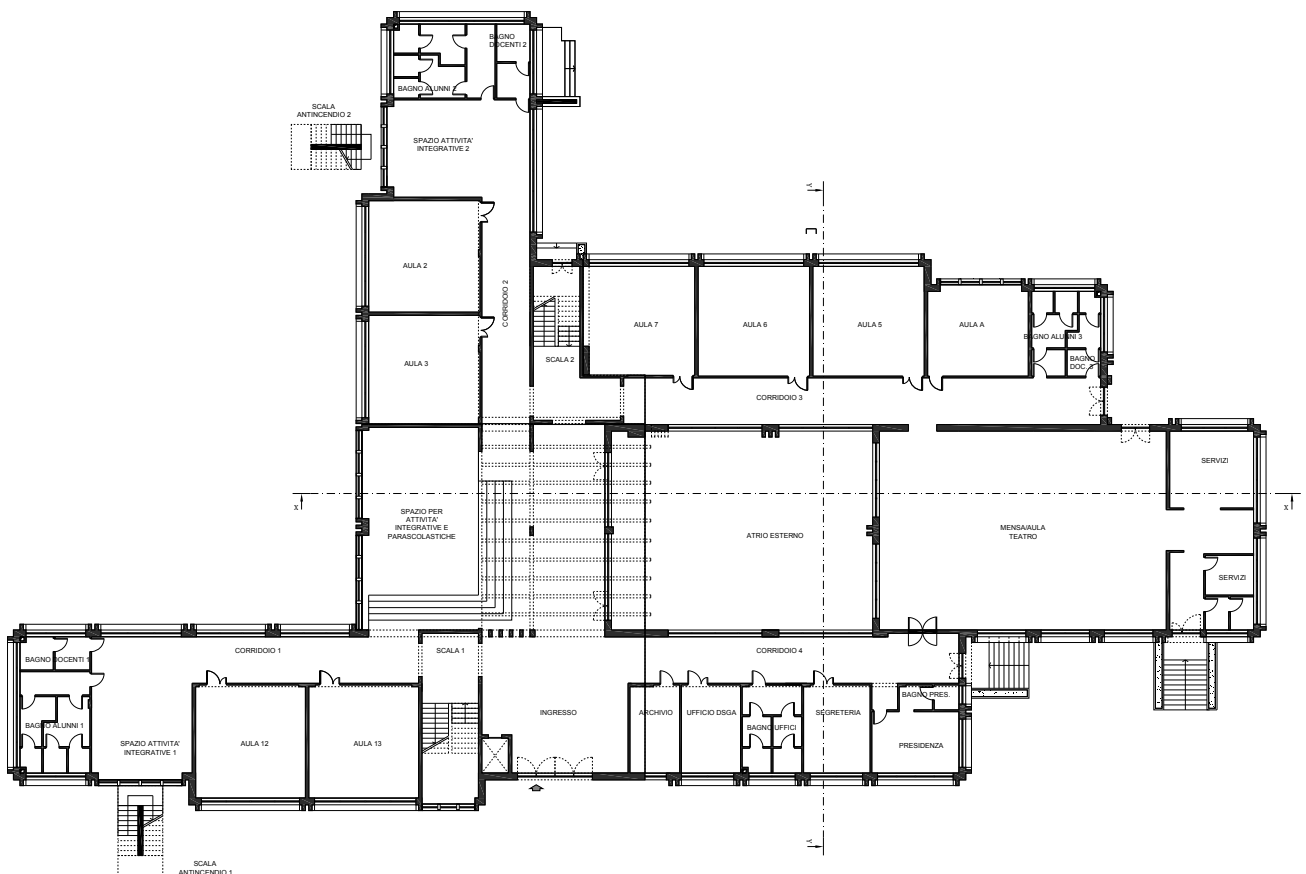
Pianta Piano Rialzato dell'Edificio
